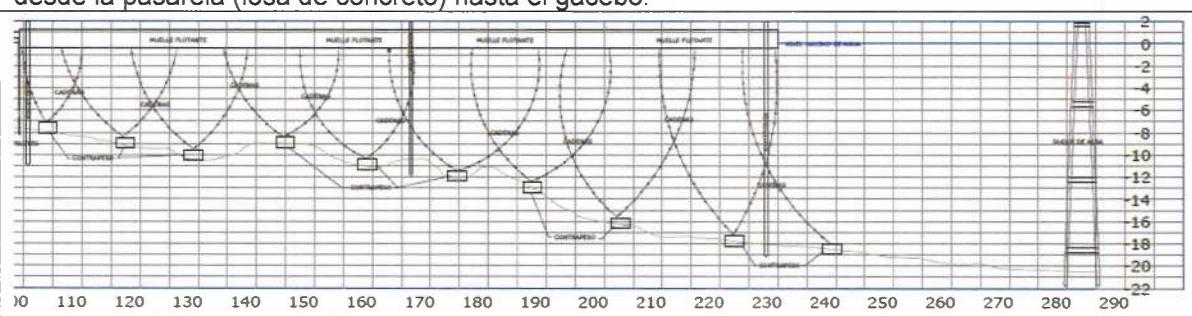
En el muelle flotante se proponen 3 pilotes, cadenas y contrapesos para estabilizar.
